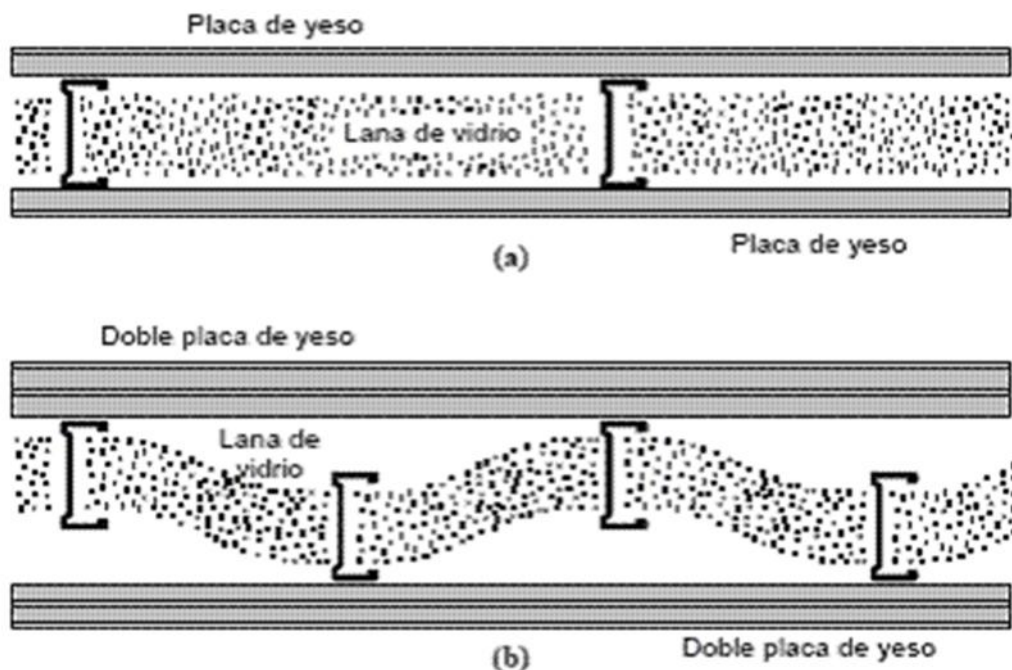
(a) Vista superior en corte de un montaje de placas de roca de yeso con estructura formada por perfiles de chapa. (b) Estructura alternada sin conexión rígida. Notar la diferencia de espesores a uno y otro lado de la pared.
